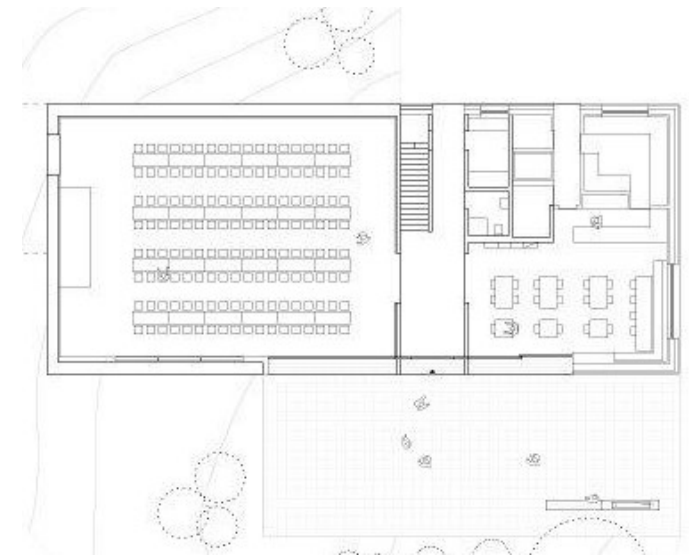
Dorfhaus Steinberg am Rofan - Grundriss
